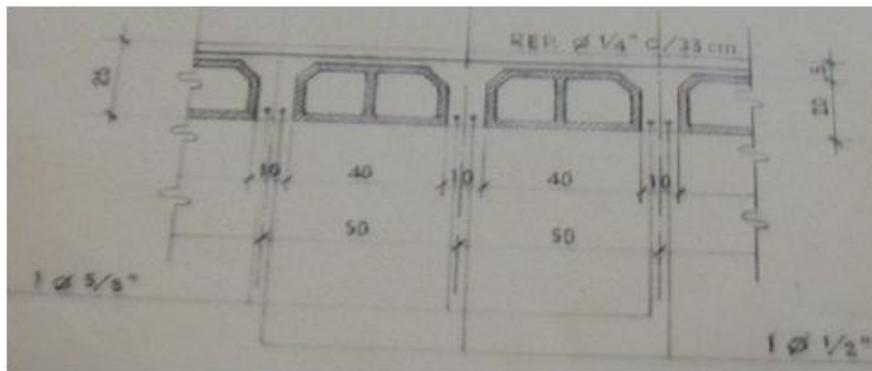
Sección Transversal del Losas del Segundo Piso.
